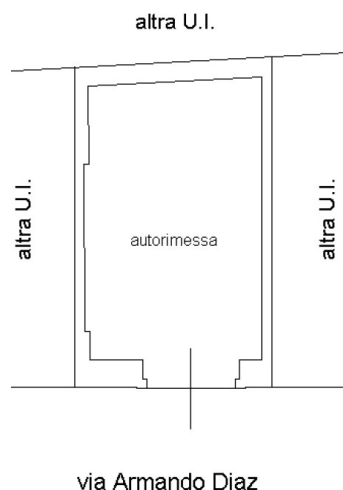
Planimetria del locale a pianterreno ubicato in via Generale Armando Diaz n° 89.
